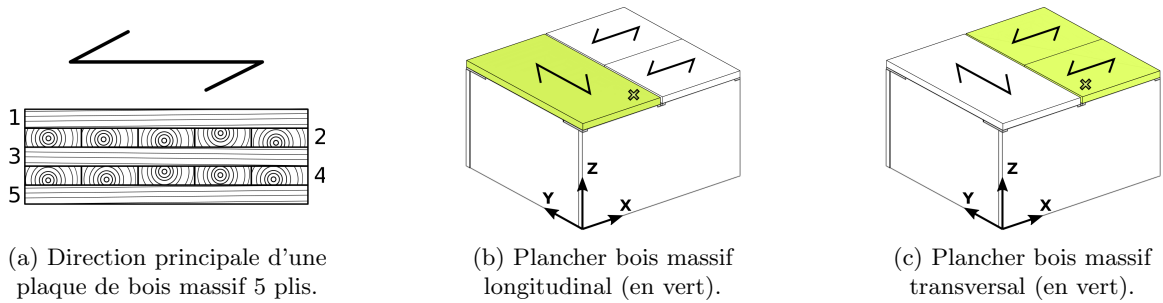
Maquette en bois massif : détails des planchers. La croix verte indique la position du pot vibrant sur chacun des planchers lors des essais expérimentaux.
